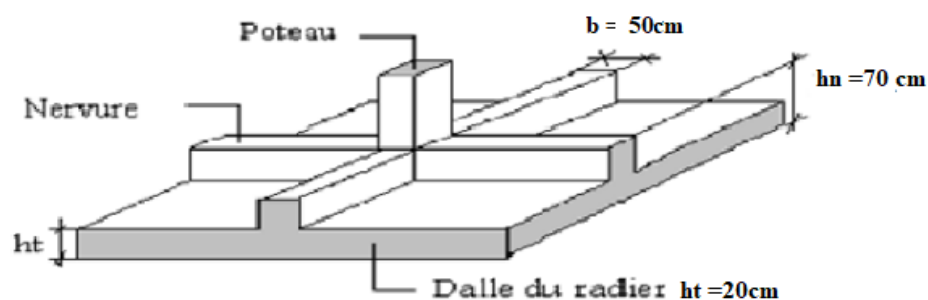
Disposition des nervures par rapport au radier et aux poteaux.
